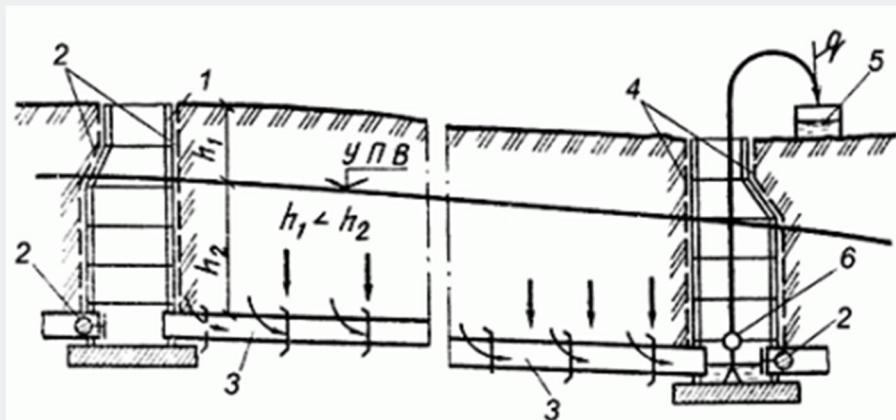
Схемы приемочного испытания безнапорного трубопровода с колодцем с наружной гидроизоляцией
